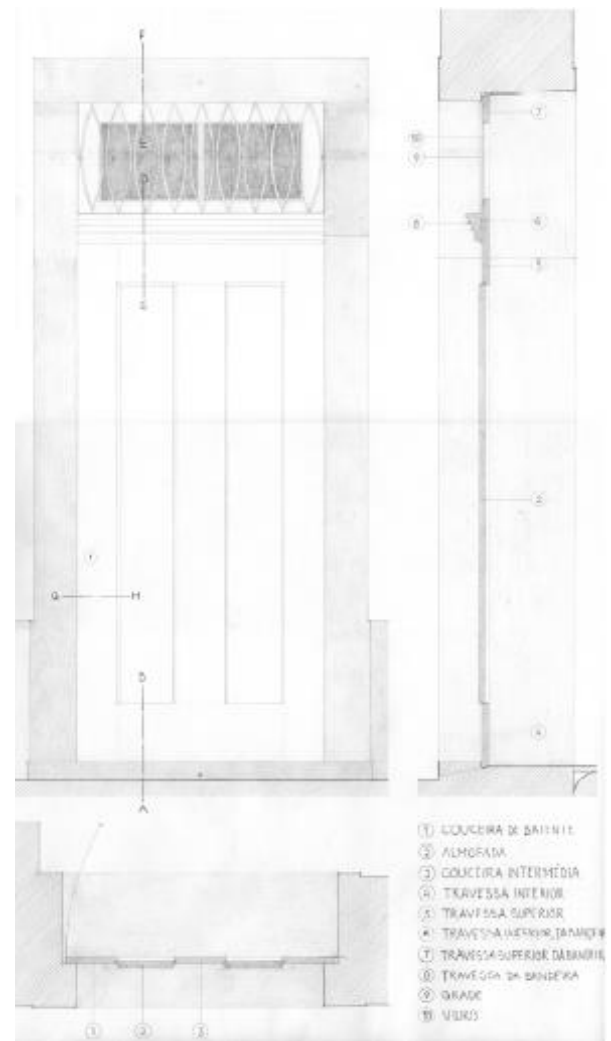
Planta, alçado e corte de um tipo de porta exterior de entrada. Fonte: Teixeira, 2004.
